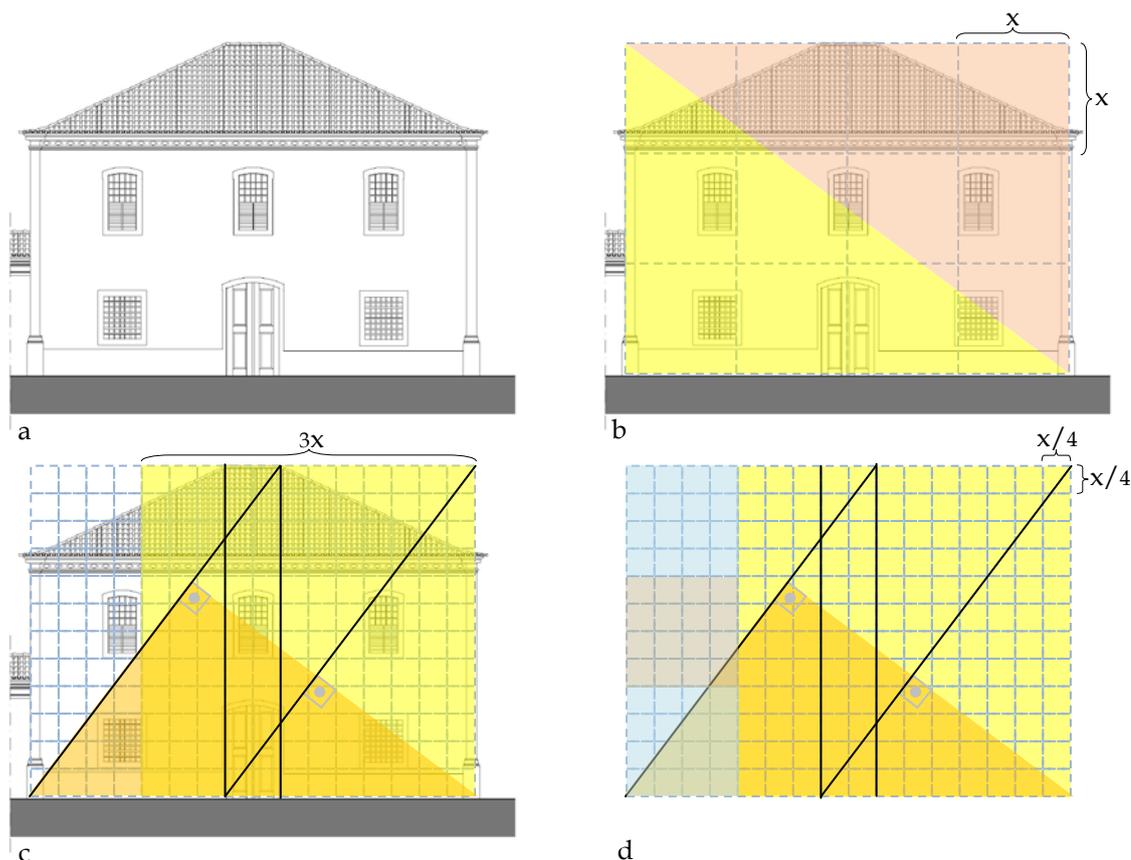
Traçado regulador da fachada da Casa de Câmara e Cadeia do Brejo da Madre de Deus.
